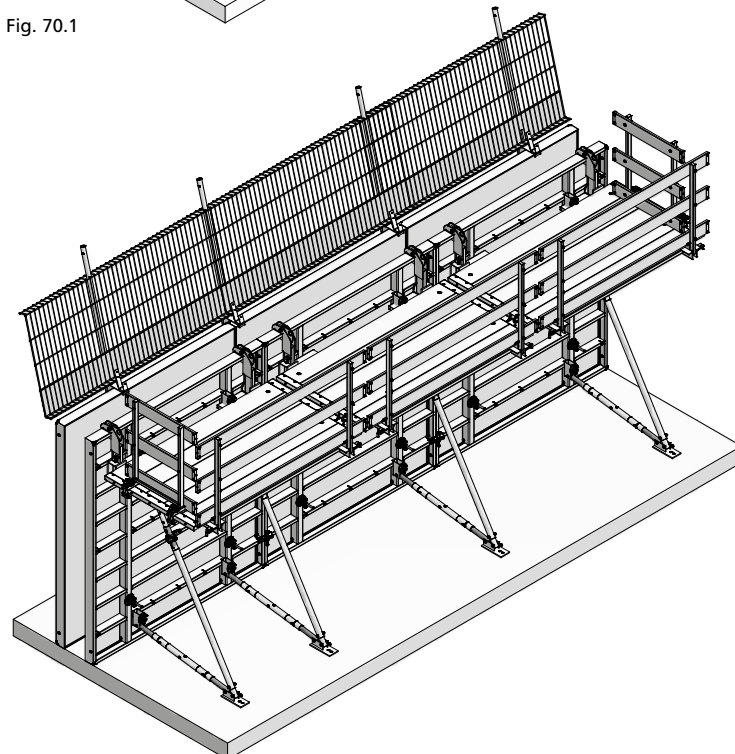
Encofrado a dos caras con apuntalamiento y andamio de trabajo en el encofrado exterior
